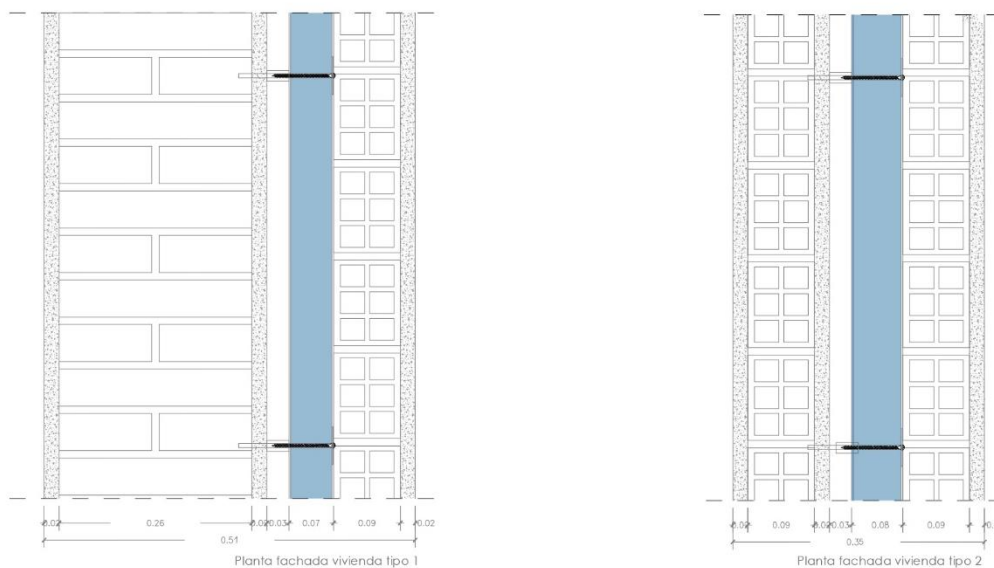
Planta del sistema vivienda tipo 1 y tipo 2 para la ciudad de Iquique. Se adjuntan especificaciones en Anexo (Detalle tipo solución 2, varía el espesor de aislamiento). Fuente: Creación propia.
